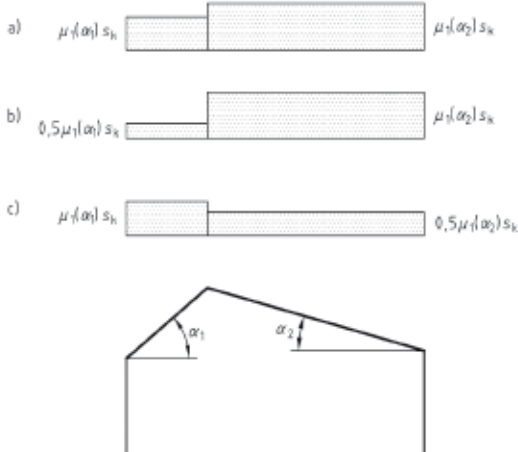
Lastkonstellationen für Satteldach nach DIN 1055-5 [2]
